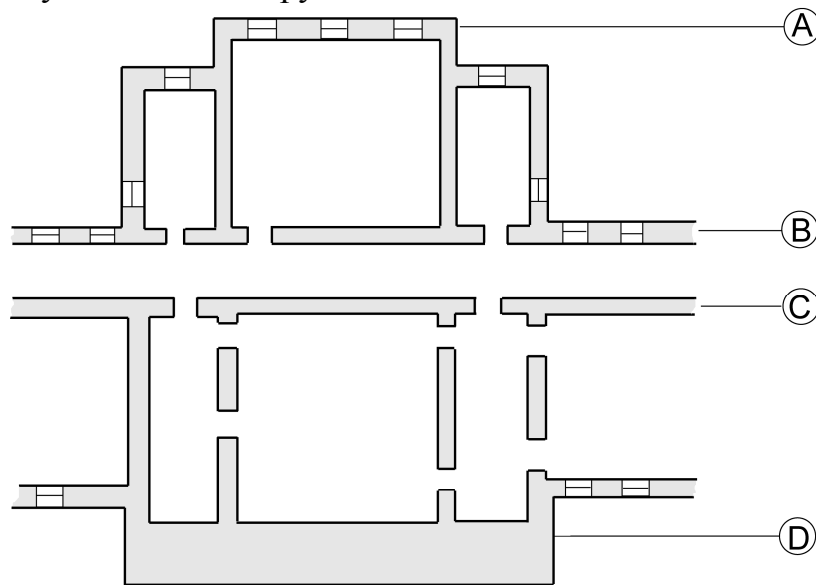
Эскиз площади сбора нагрузок для главного корпуса НГУ
